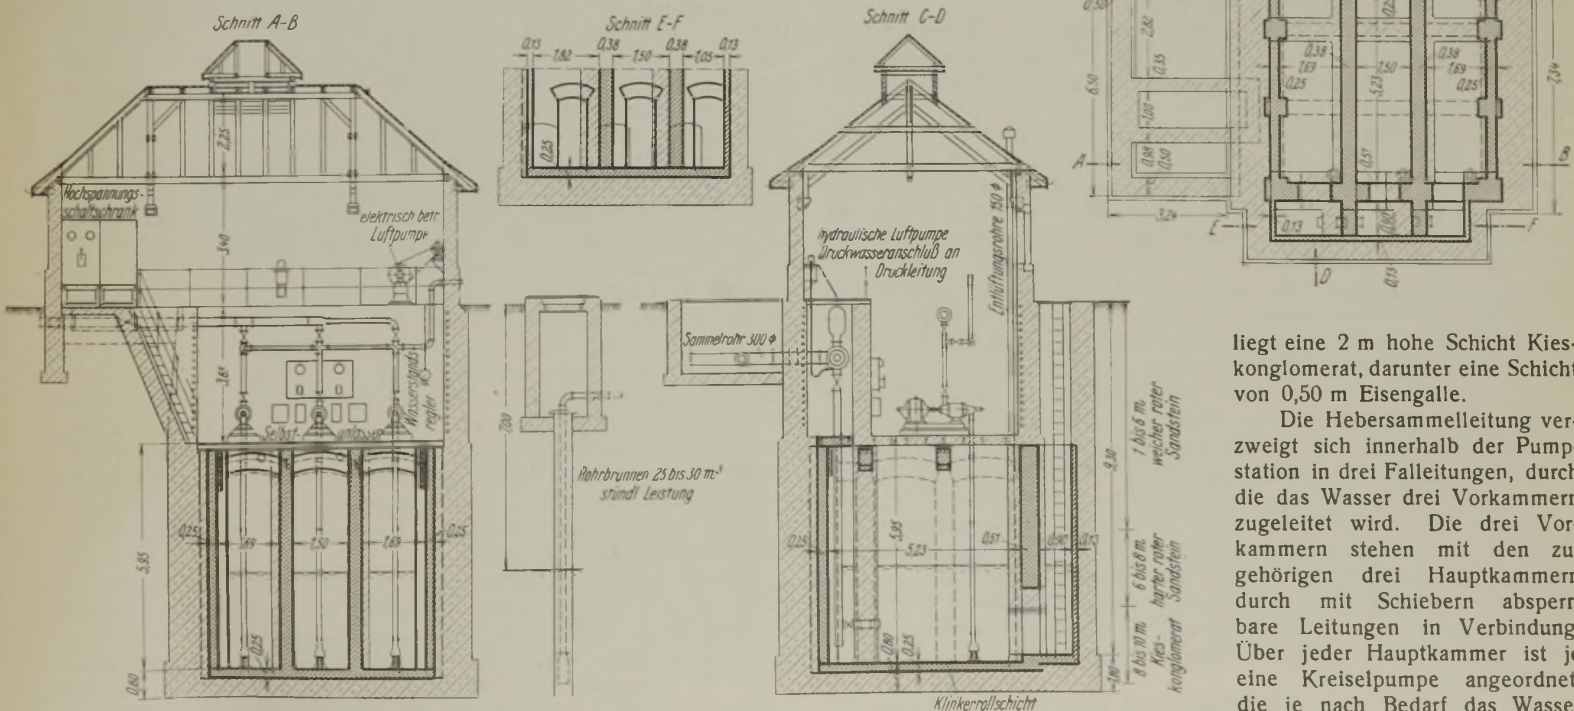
Brunnenkammern mit Pumpstation, Grundriß und Schnitte.
